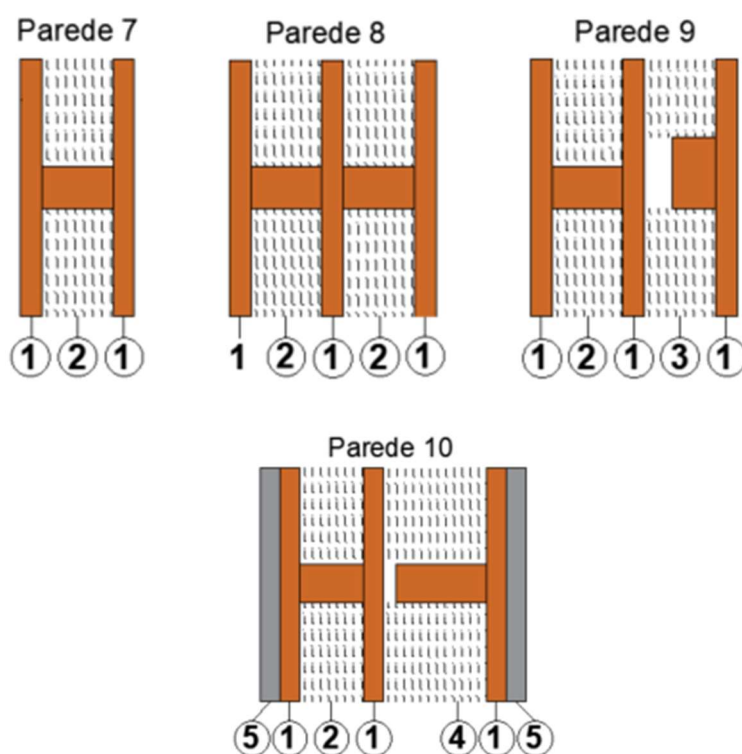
Secção transversal das quatro paredes ensaiadas, com dimensões normalizadas onde se ilustra esquematicamente as condições de montagem. Materiais: 1 – Uma placa de Superpan H tech P5 E-Z de 15 mm (aparafusada a uma estrutura de barrotes de madeira, quando adjacente); 2 – Caixa de ar formada por estrutura de barrote de madeira com 50 x30mm de espessura, preenchida com lã mineral (40 kg/m³) com 50 mm de espessura; 3 - Caixa de ar com 50mm, formada por estrutura desacoplada de barrote de madeira com 50 x30mm de espessura (colocados ao alto) preenchida com lã mineral (40 kg/m³) com 50 mm de espessura; 4 – Caixa de ar com 80mm, formada por estrutura desacoplada de barrotes de madeira com 70 x30mm de espessura e placa de lã mineral (40 kg/m³) com 80 mm de espessura; 5 – Placa de gesso cartonado (12.5 mm).
